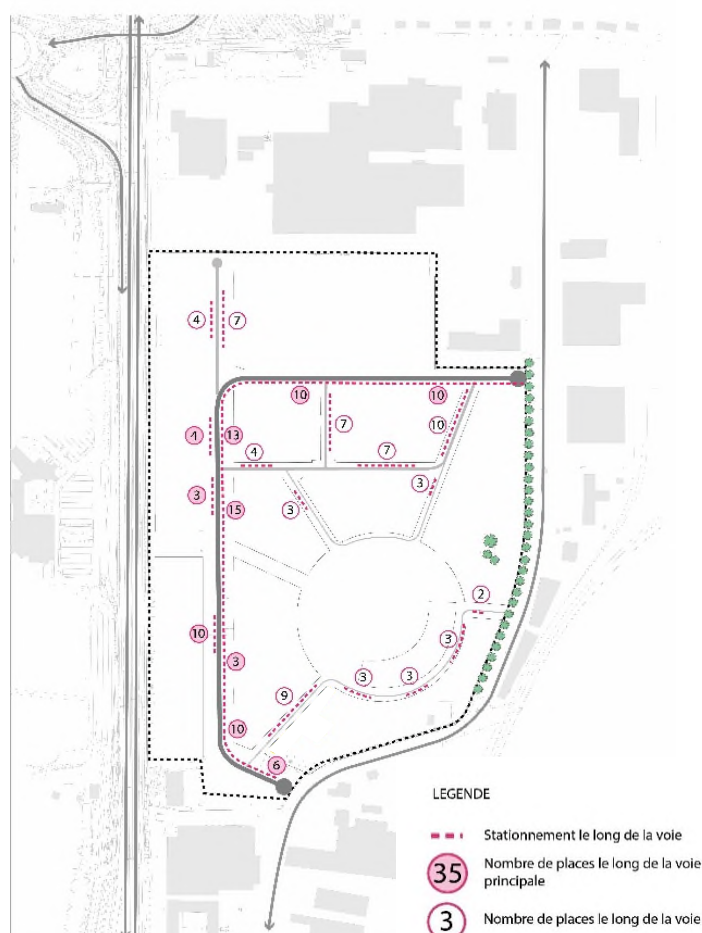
Plan schématique prévisionnel du stationnement sur l'espace public
